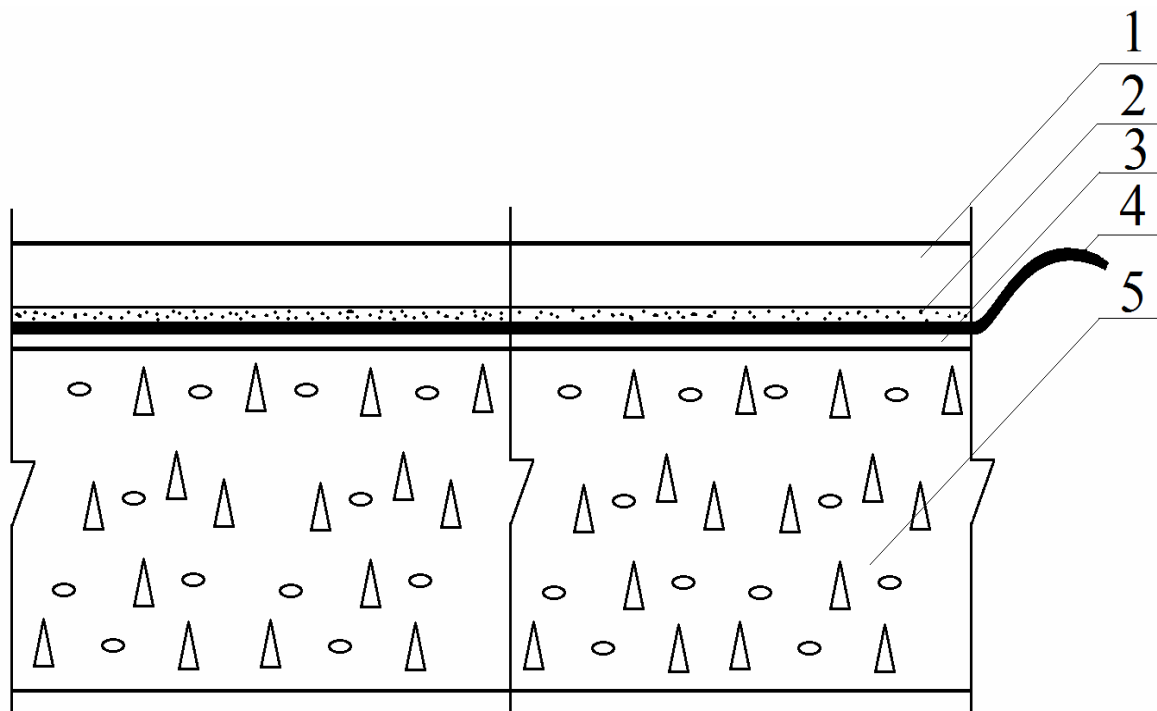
Полимерные антистатические покрытия для бетонной плиты на грунте
